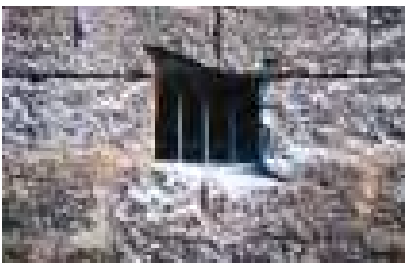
Detalle de ventanal de A.Gaudí en la fachada sur de la Catedral de Palma
